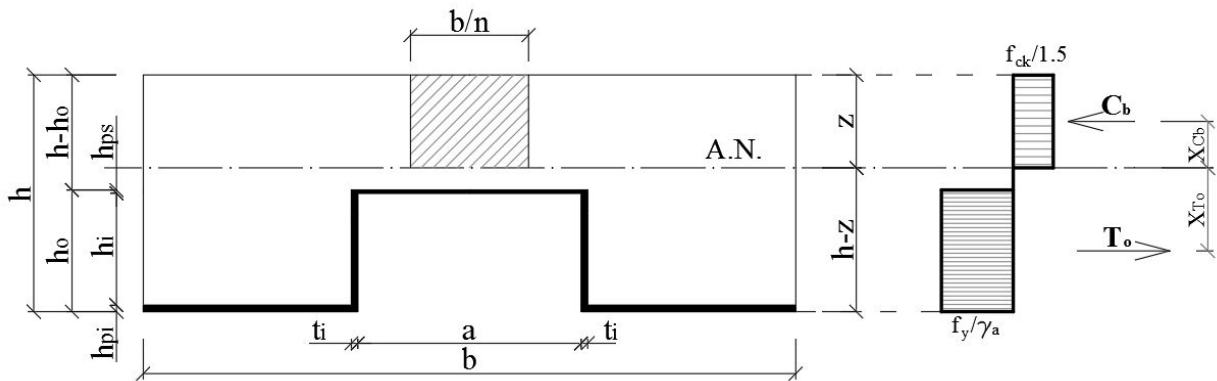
2. Model de calcul al structurii mixte oțel-beton cutată
